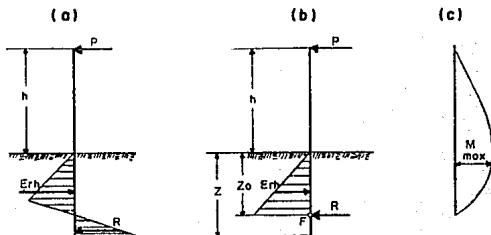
Tablestacado empotrado en el terreno (carga lineal)
